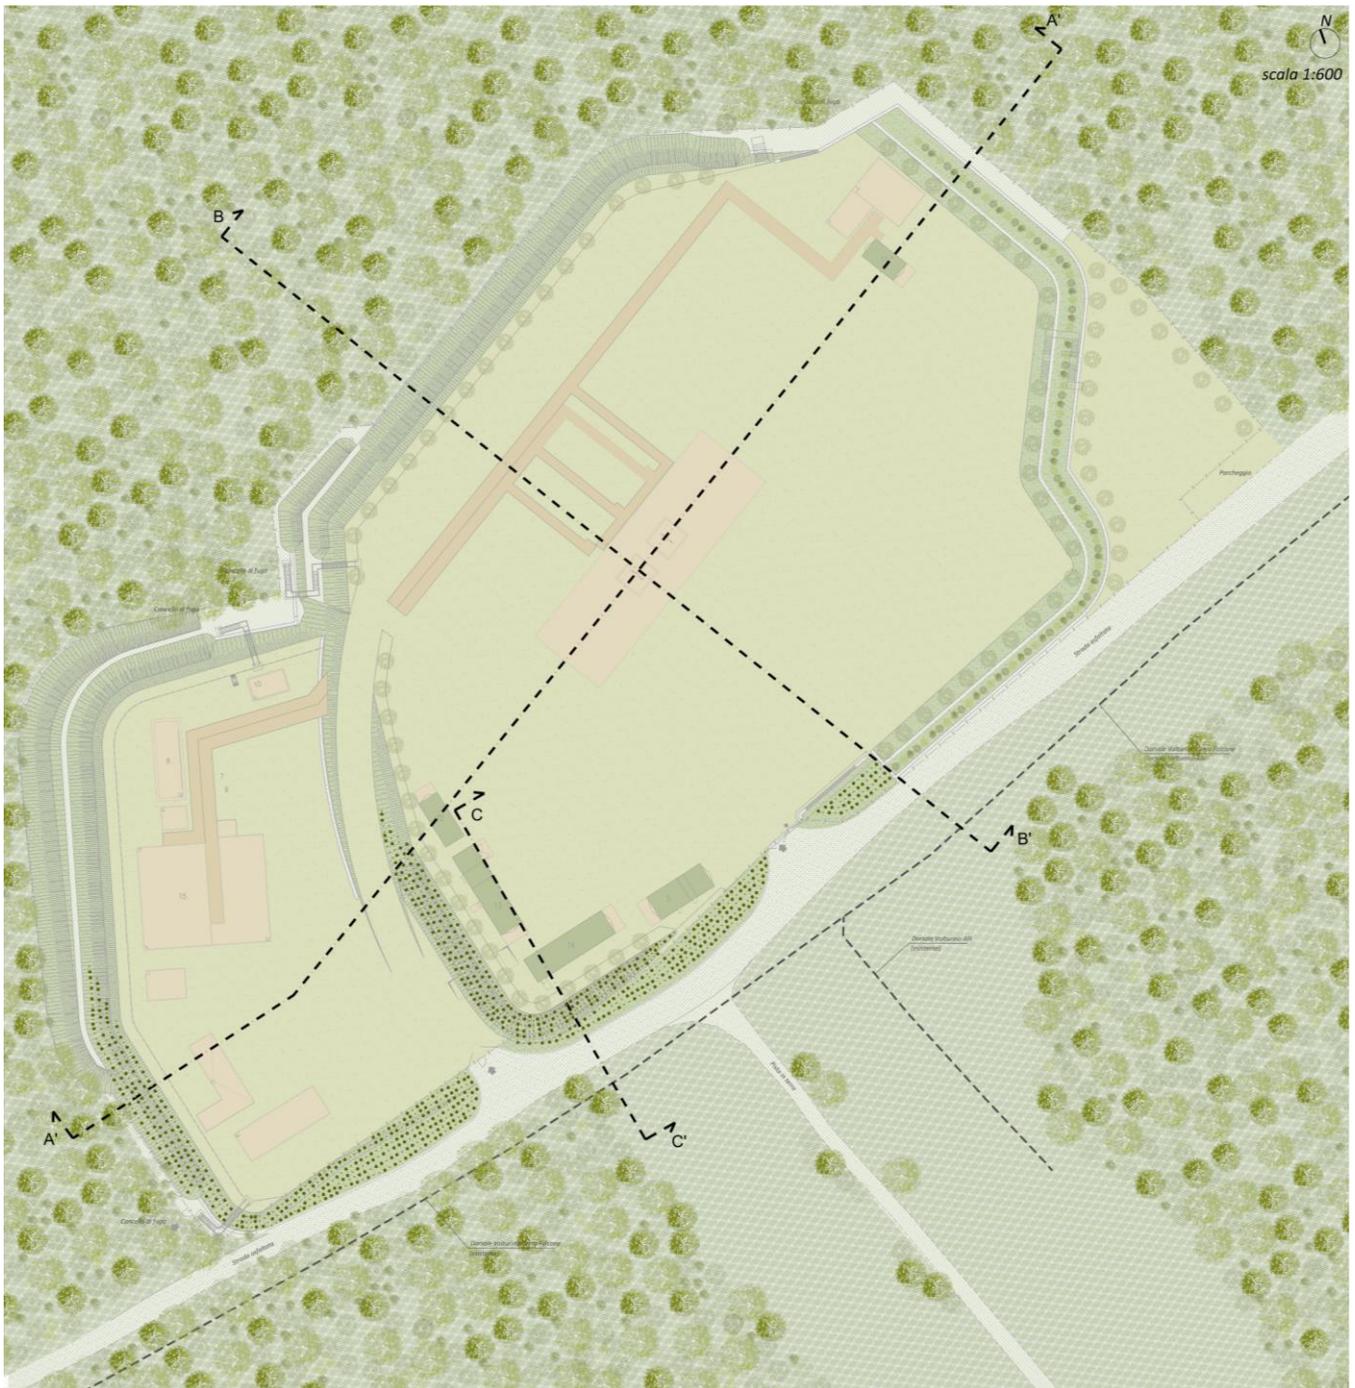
Planimetria generale di progetto delle opere a verde – Elaborazione LAND Milano.
